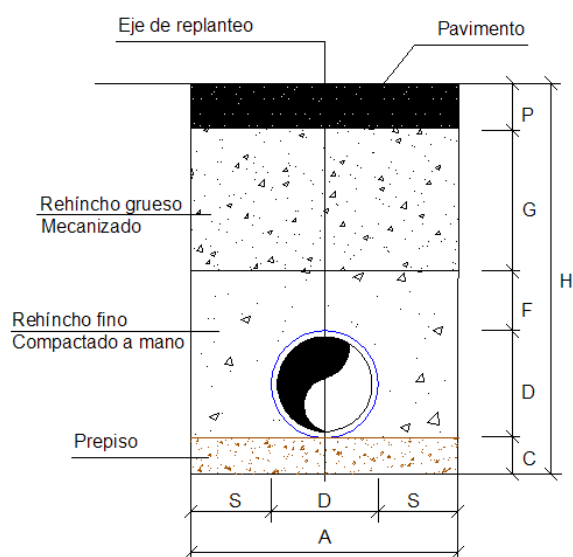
Esquema que muestra los parámetros de la zanja. (Hechavarría, 2009).
